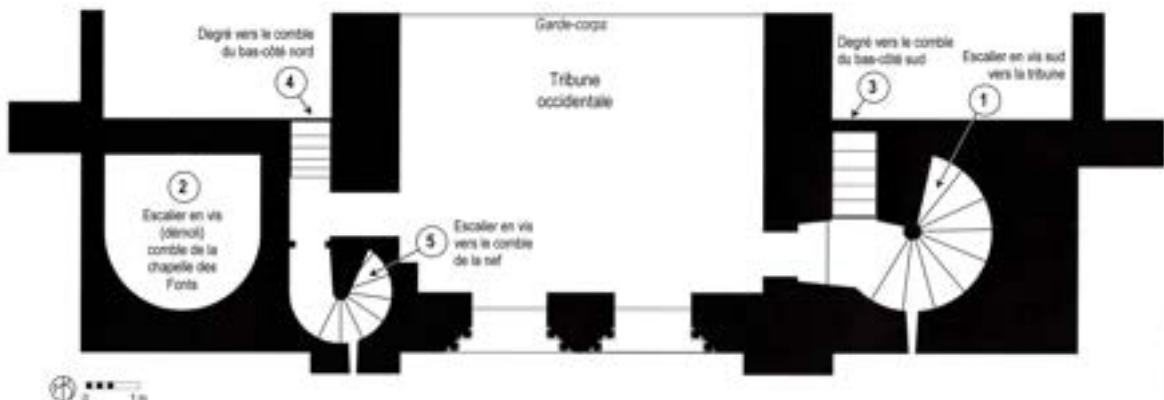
Lillers. Plan du massif occidental (rez-de-chaussée)
